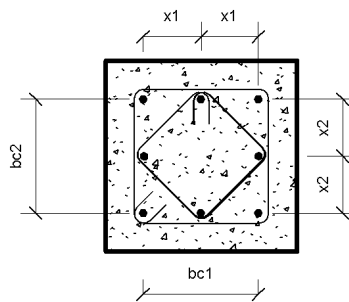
Representación del refuerzo transversal de las columnas SFM
